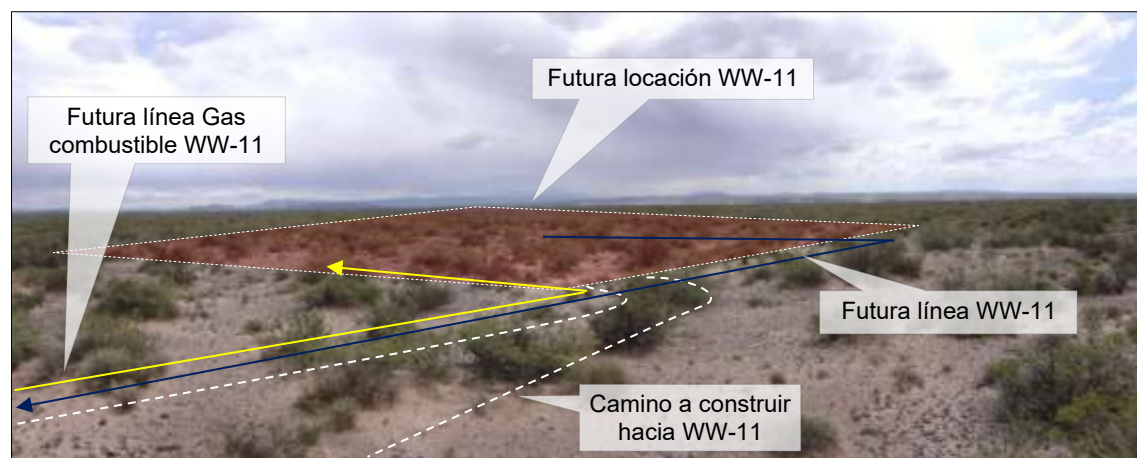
Vista en dirección Noroeste. Se observa el predio del futuro pozo WW-11 y el camino a construir sobre terreno natural para ingresar por el sector Este de la futura locación. Se aprecia en azul el
